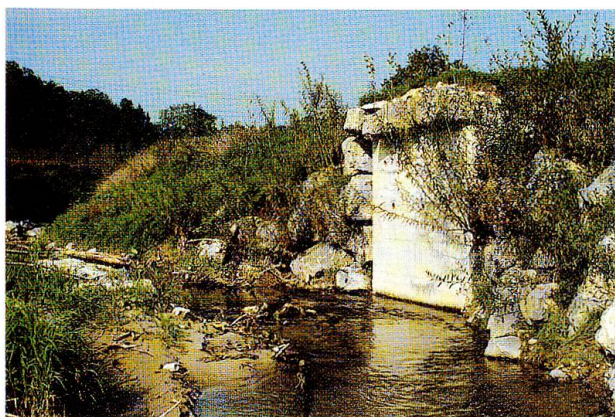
Rotbach, Gemeinde Eschenbach: Eisvogelburg aus Beton und Blocksteinen, 18. 9. 1992.
